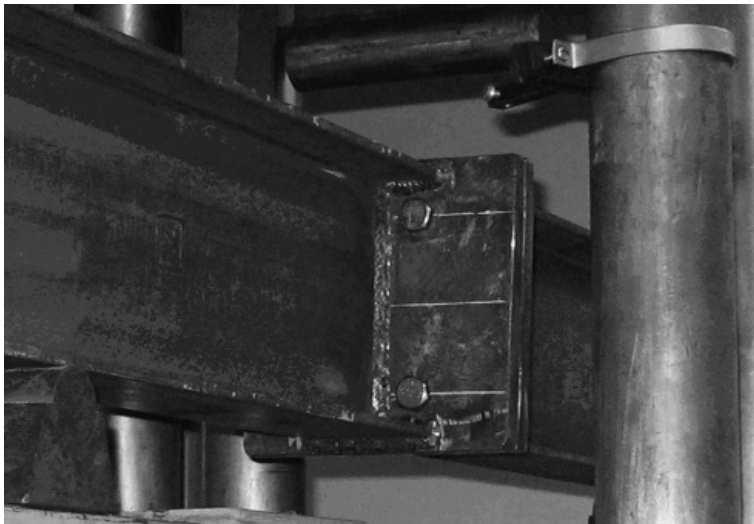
conexión a momento viga-viga, del tipo “flush end plate”
